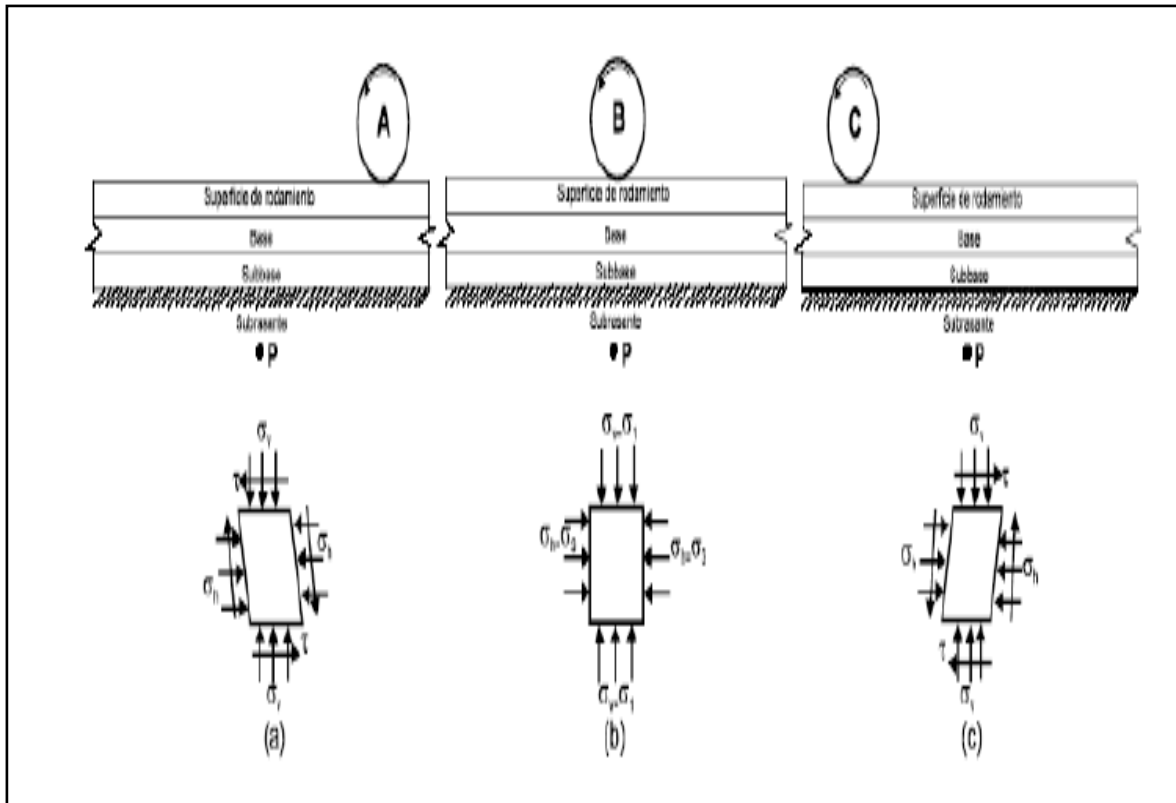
Estado de esfuerzos en una sección longitudinal de un pavimento.
